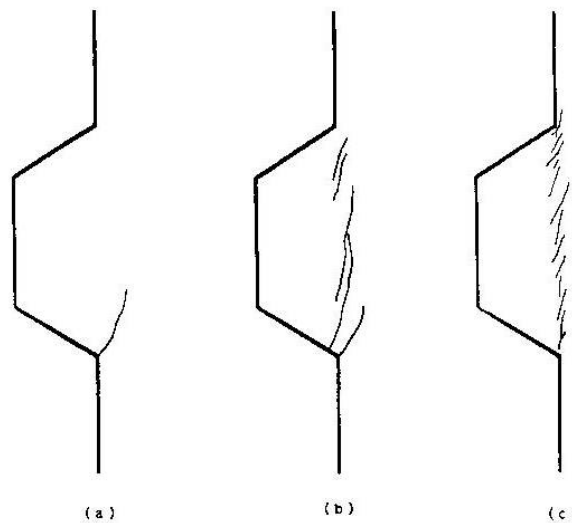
Secuencia de fisuras en la junta seca con una llave [11]
